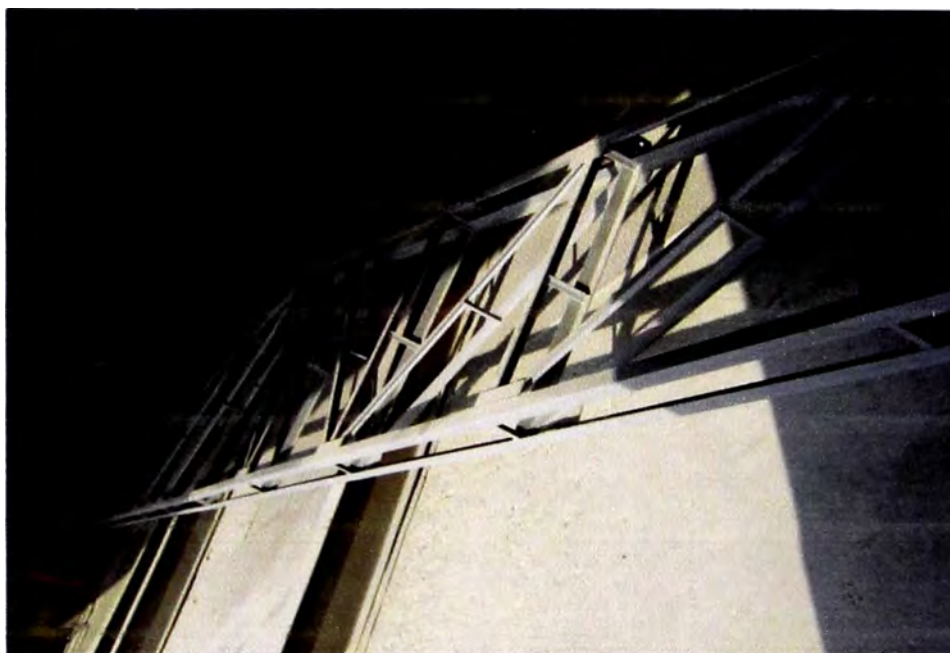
Inspección de pase acabado en columnas C-13, soldador w1.
